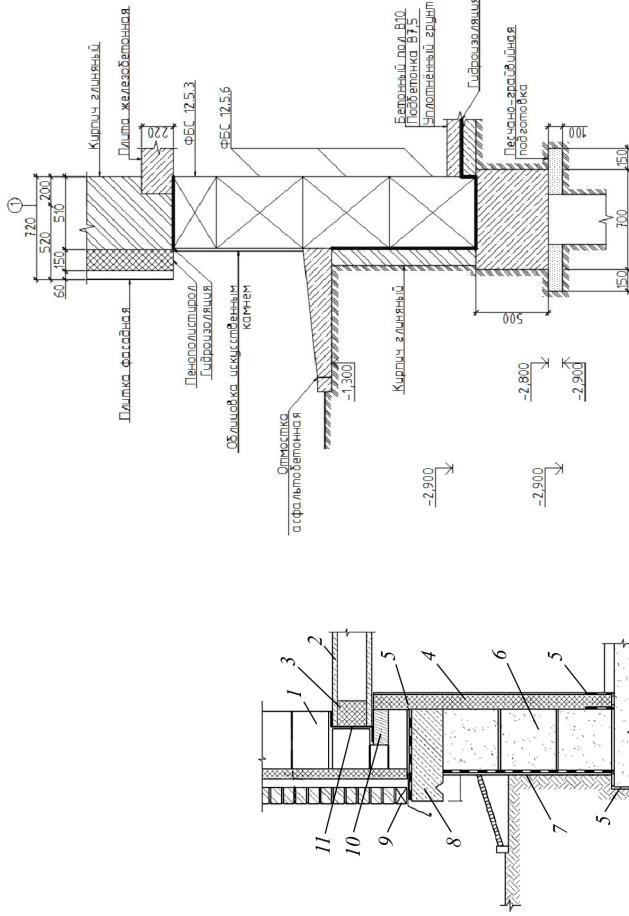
Конструктивные решения цоколя из блоков: *a* – при кладке стен из блоков с облицовкой лицевым кирпичом: *1* – газобетонный блок; *2* – железобетонное перекрытие; *3* – теплоизоляционный вкладыш; *4* – жесткий утеплитель; *5* – гидроизоляция; *6* – фундаментный блок; *7* – наружный отделочный слой; *8* – монолитный железобетонный пояс; *II* – воздухозащитная пленка; *9* – при кладке стены из кирпича отверстие; *10* – монолитный железобетонный пояс; *b* – при кладке стены из кирпича (выполнил студент В.С. Пономарев, гр. ПГС 13-26)
